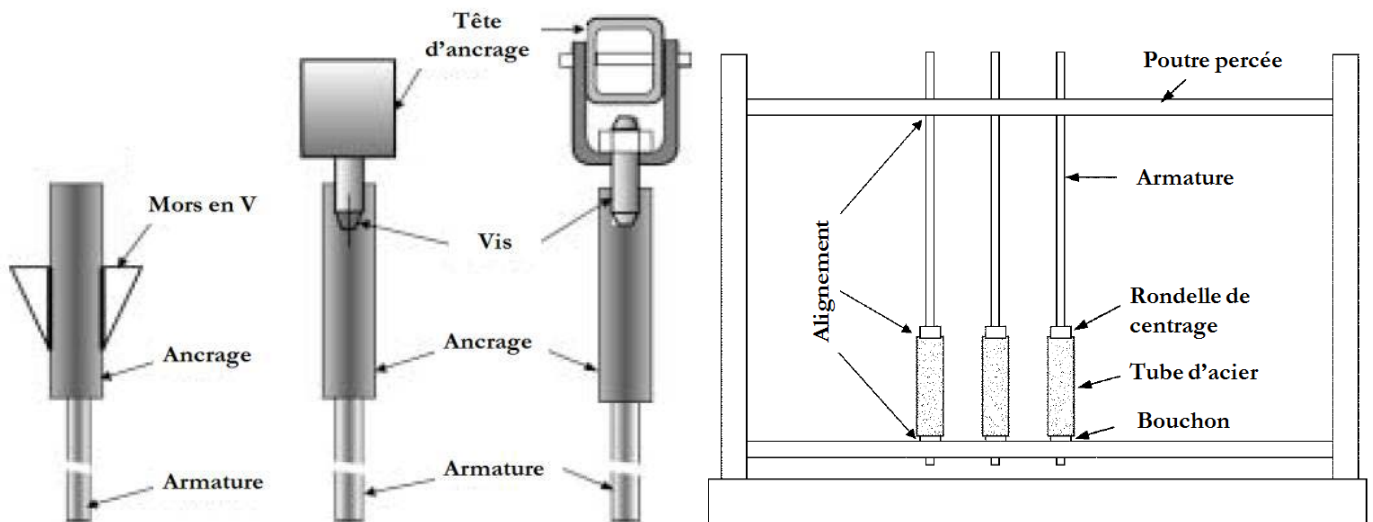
Propositions d'ancrages pour essais de tractions sur armatures PRF.
